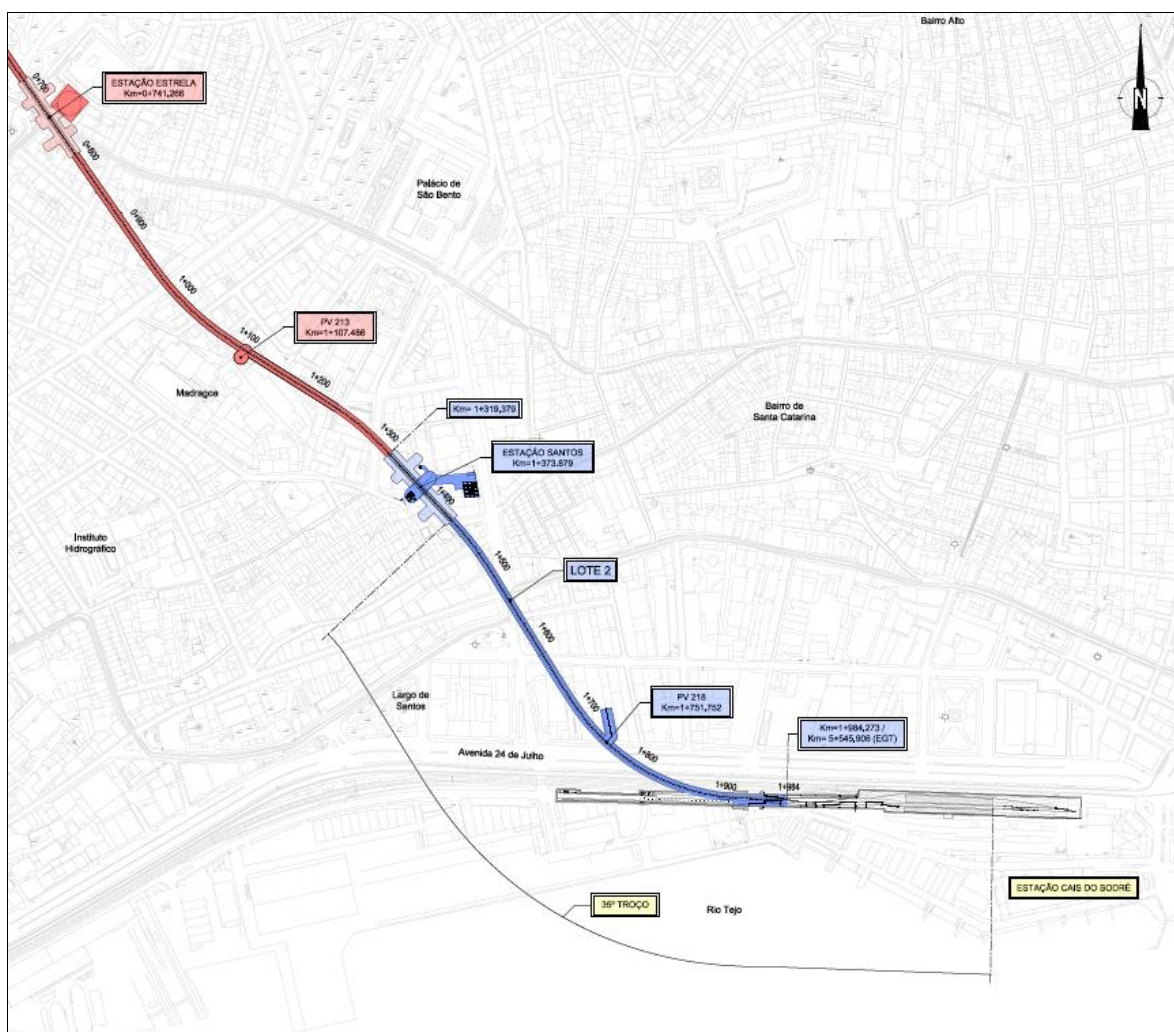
Planta de Enquadramento Geral (Lote 2 a azul)
